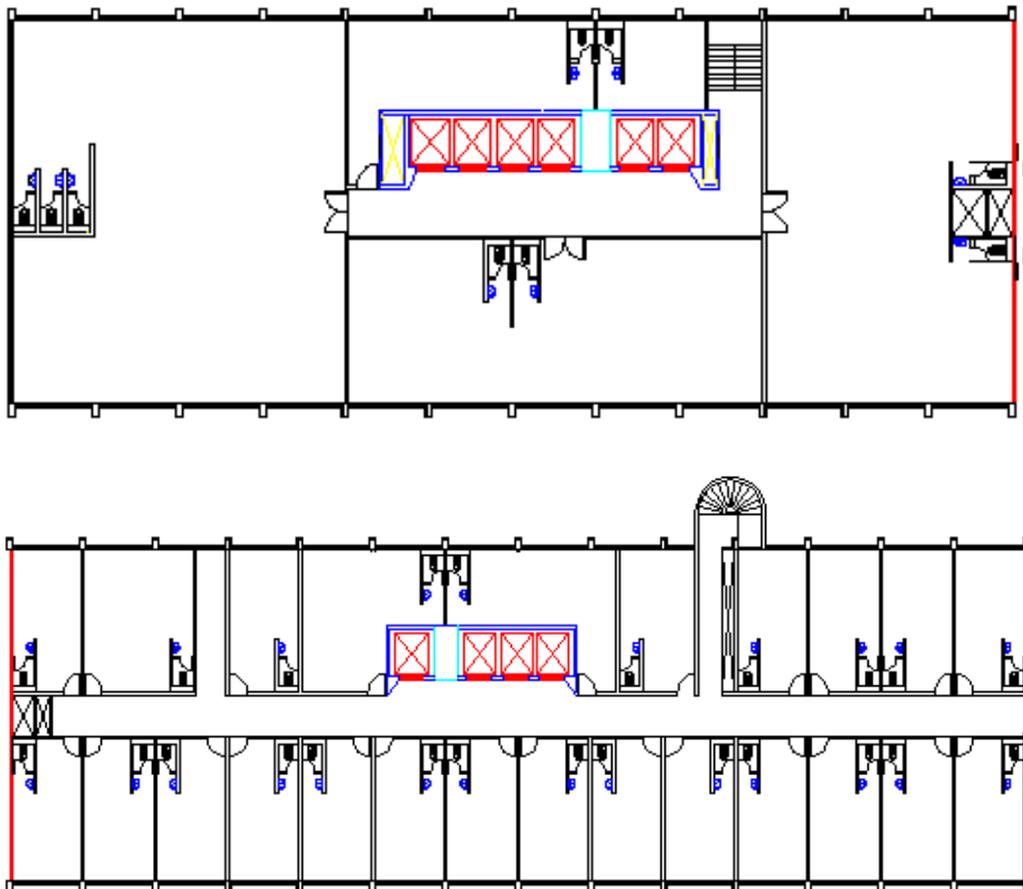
Dois blocos que compõem parte do pavimento-tipo. Acima Horsa 2 grandes conjuntos e abaixo Horsa 1 salas comerciais de aproximadamente 40 m<sup>2</sup> de área (privativa e comum)
